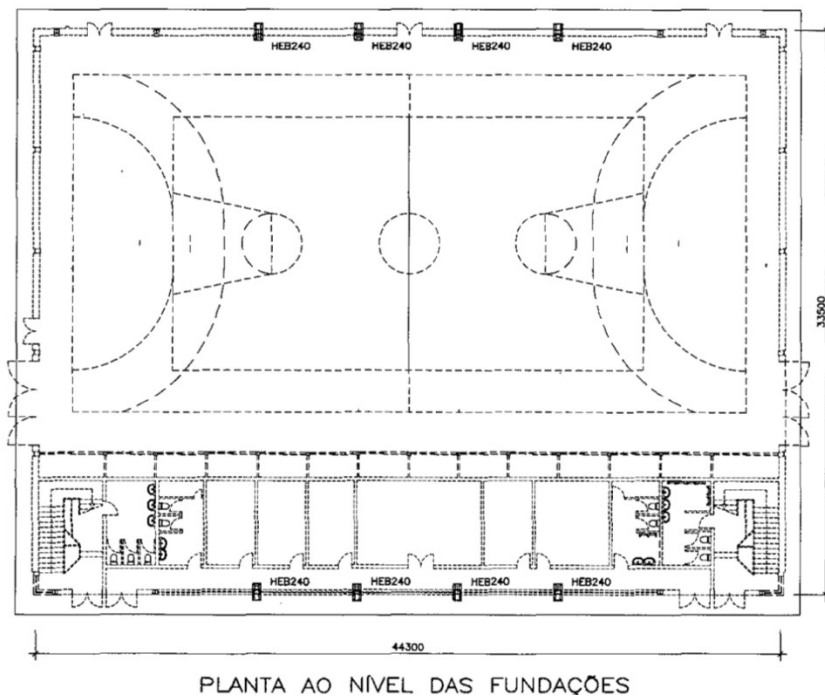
Planta do edifício que consta do projeto de reforço de 2002.
